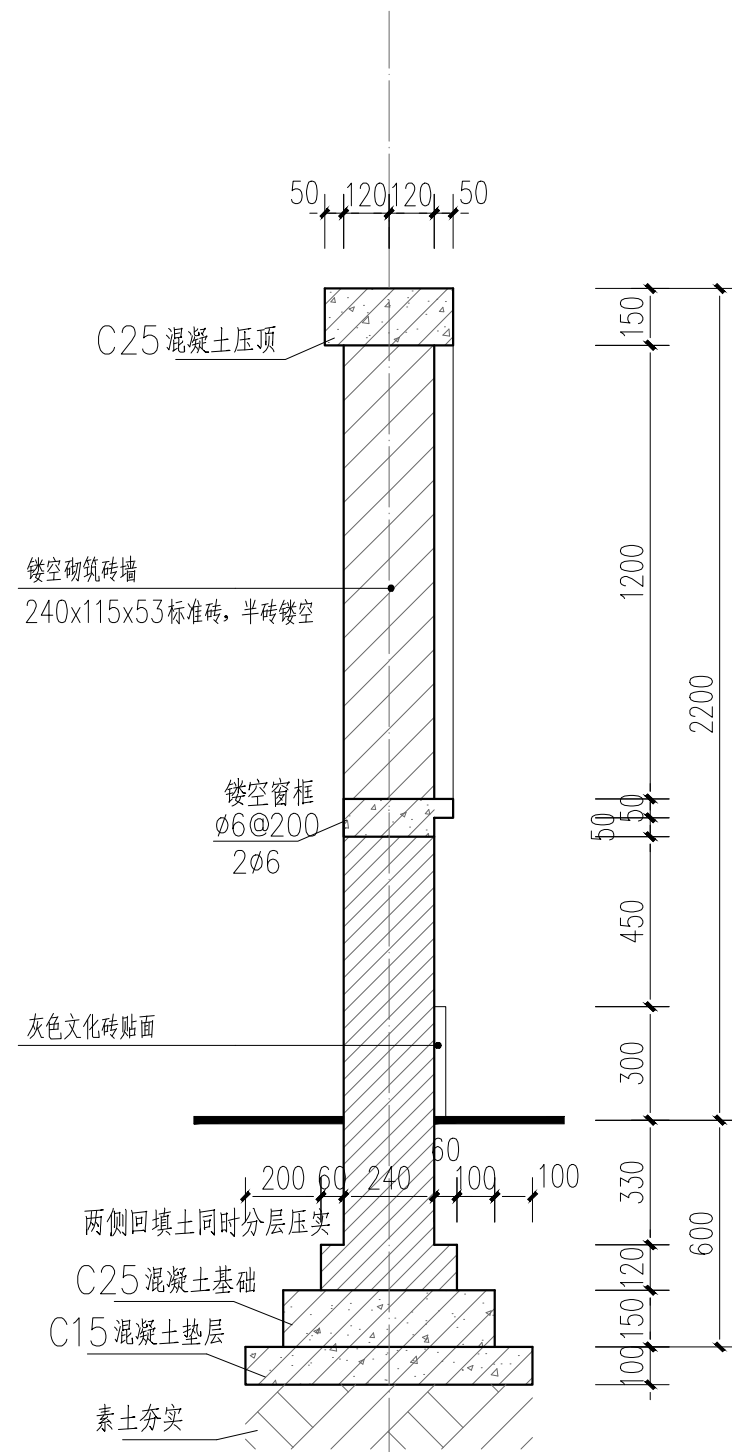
围墙大样	图纸编号	建详-15	建筑
